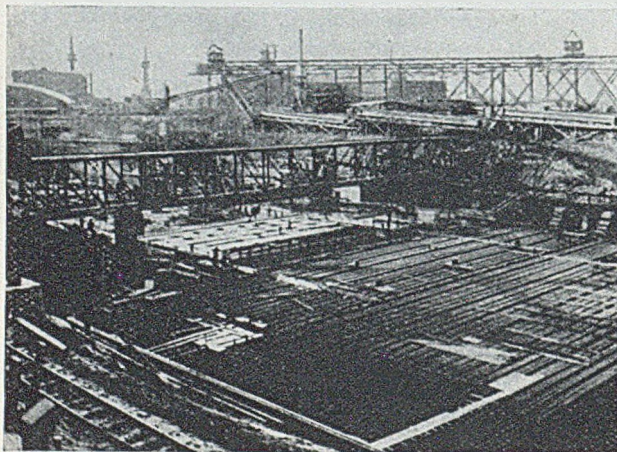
Betonieren der Sohle, unter der Betonierbrücke ein mit Holztafeln abgedeckter Sohlenblock.
